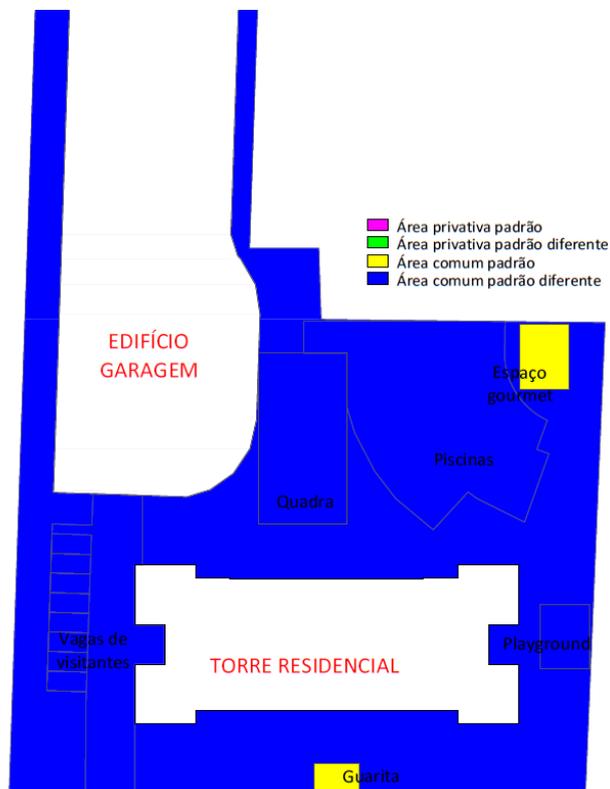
Divisão de áreas do pavimento térreo da torre residencial do Projeto C
